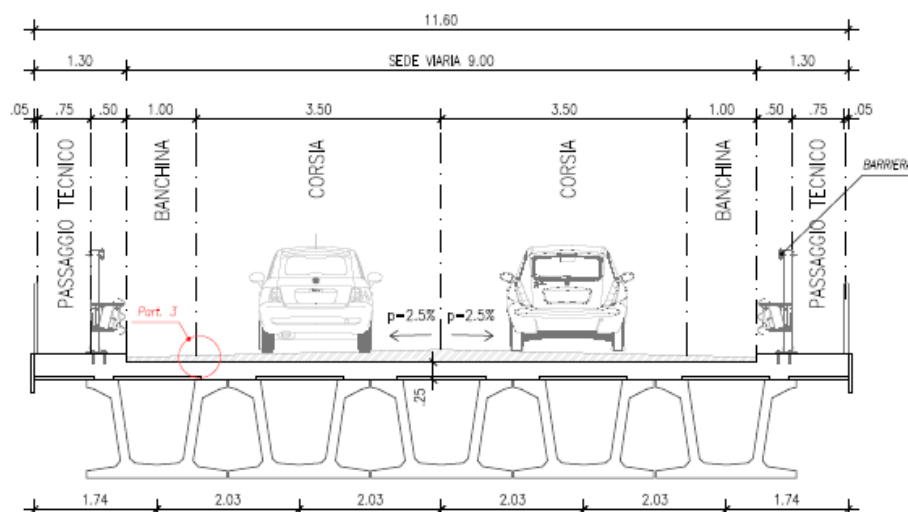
Sezione tipo Ponte su Rampa di accesso A11
